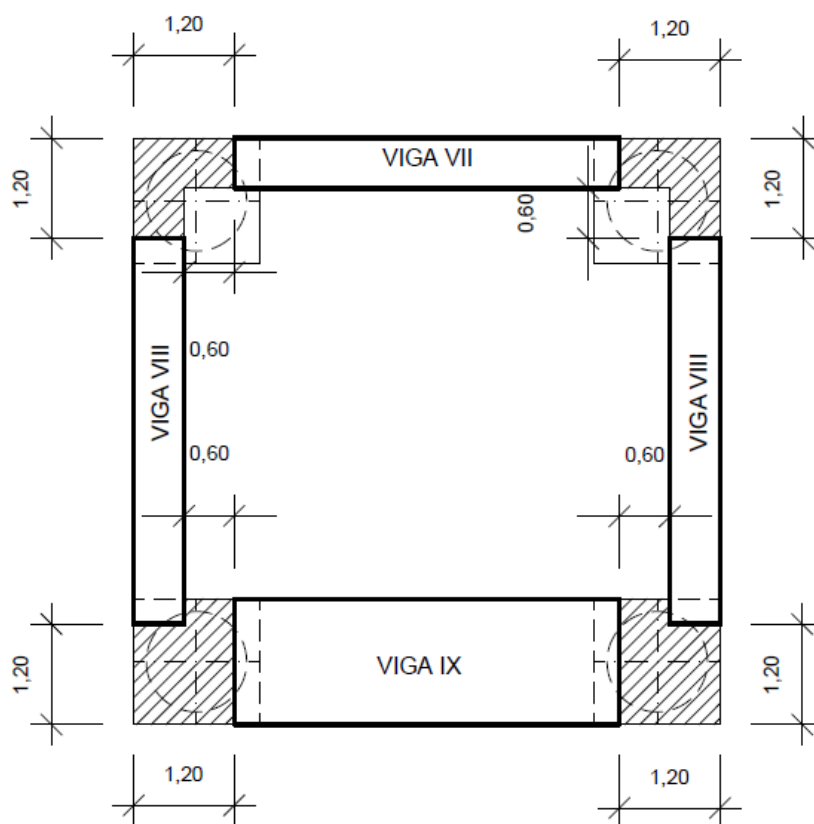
Situación de las esquinas hormigonadas en segunda puesta.
